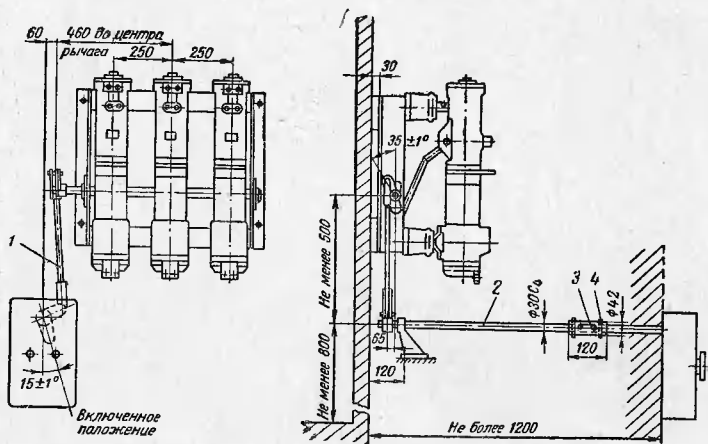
Установка выключателя типа ВМП-10 с приводом типа ПЭ-11.
